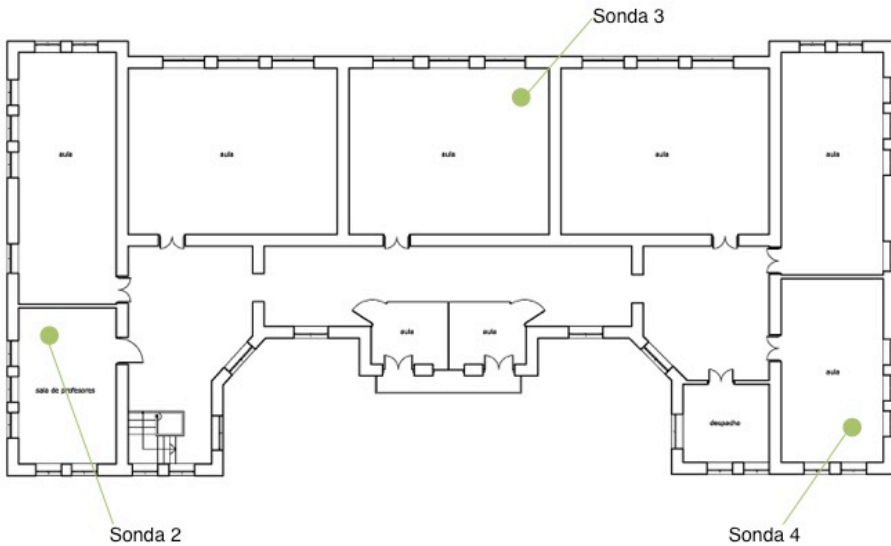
Plano de situación de las sondas de temperatura y humedad. C.E.I.P. Fabián y Fuero, Planta Primera (Fuente: Elaboración propia).
